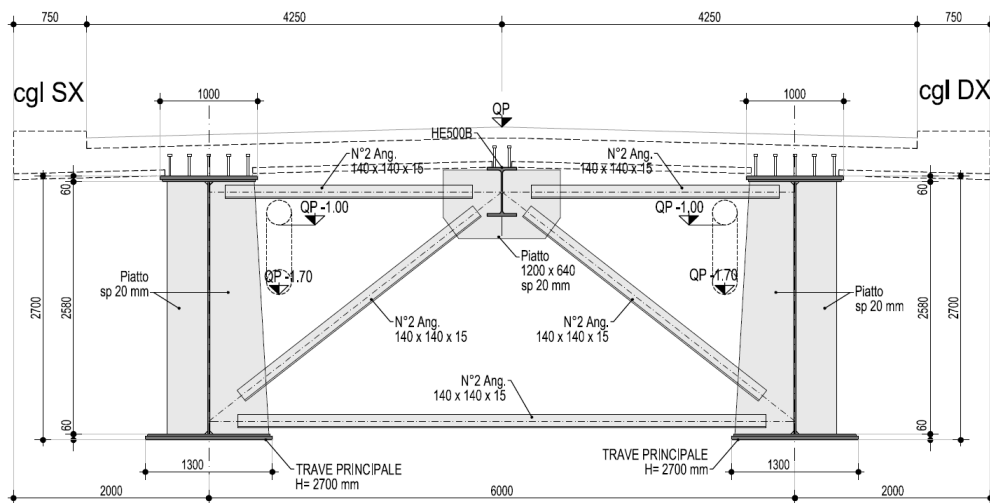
SEZIONE TRASVERSALE IMPALCATO IN CAMPATA 2
